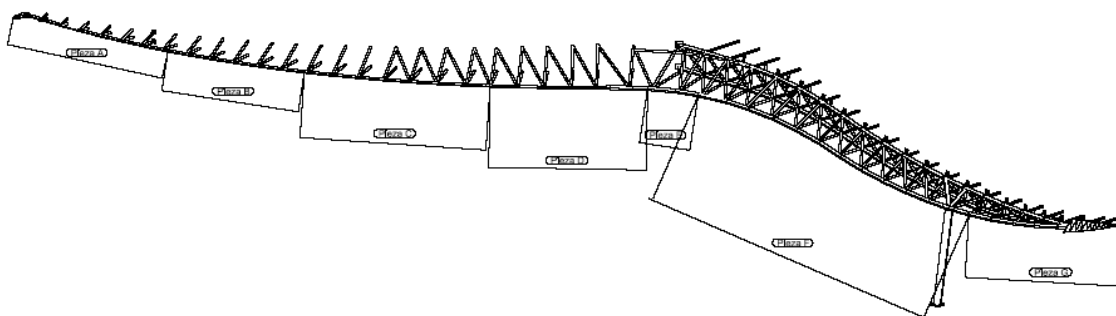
Parts de l'estructura d'acer de coberta que s'assemblaran a obra
